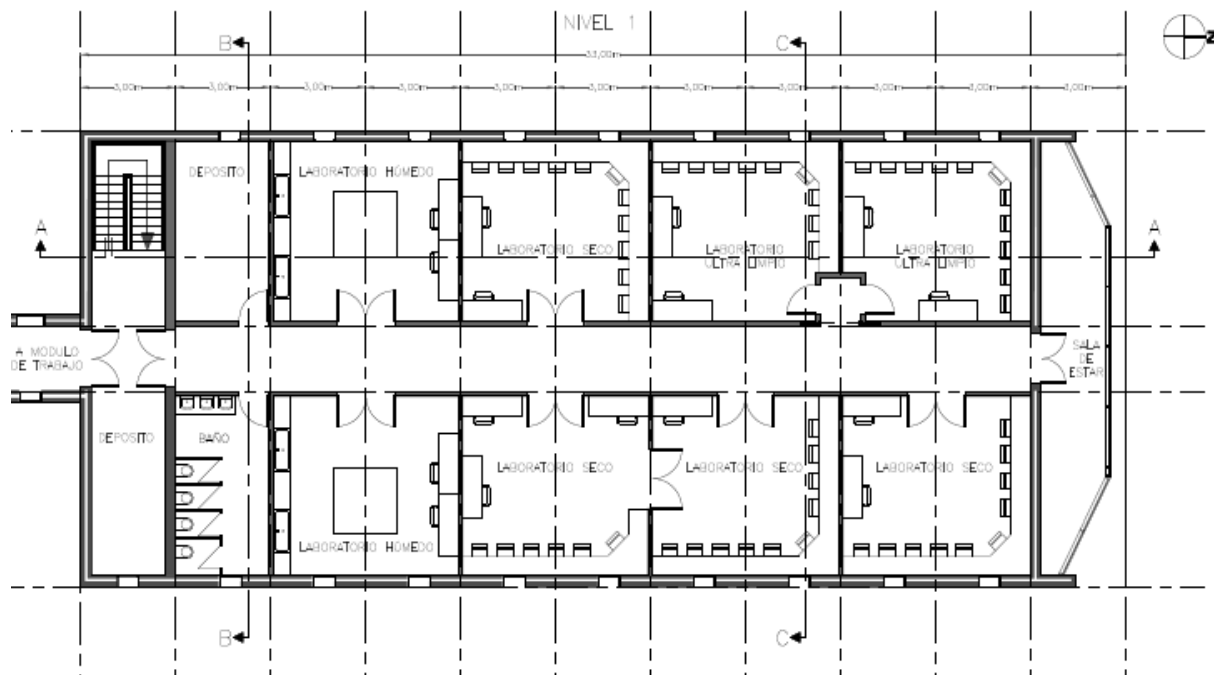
vista en planta de la Planta 1 del Edificio de Laboratorios
